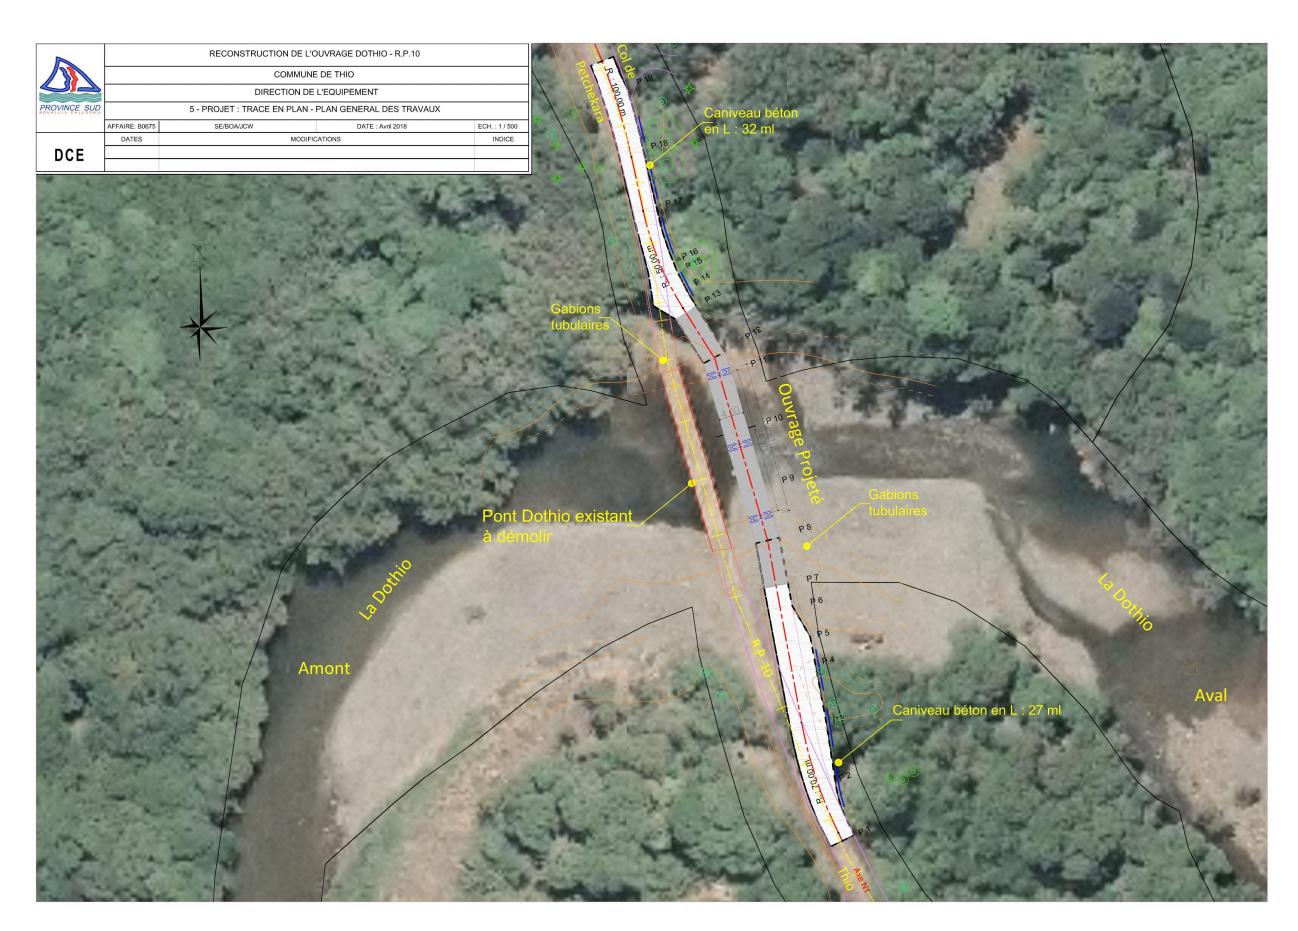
tracé en plan de l'ouvrage Dothio projeté (source: DEPS, 2018).
